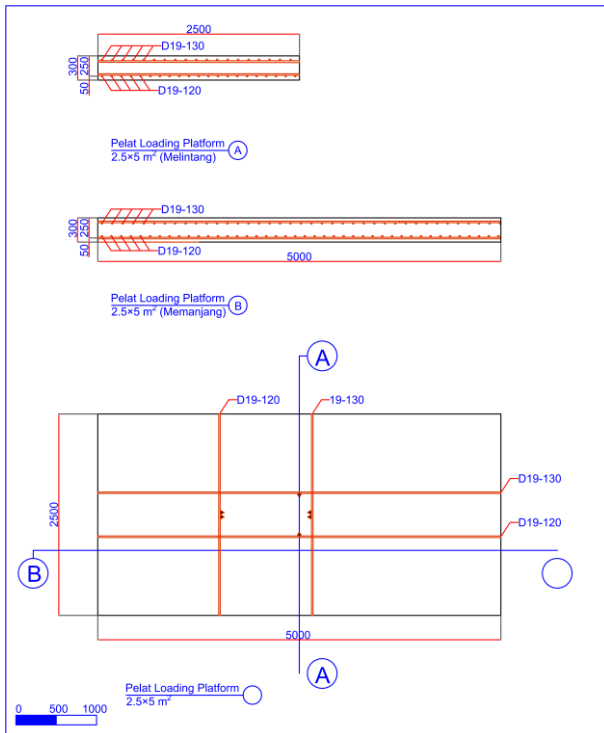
Penulangan pada balok Loading Platform dan Trestle
